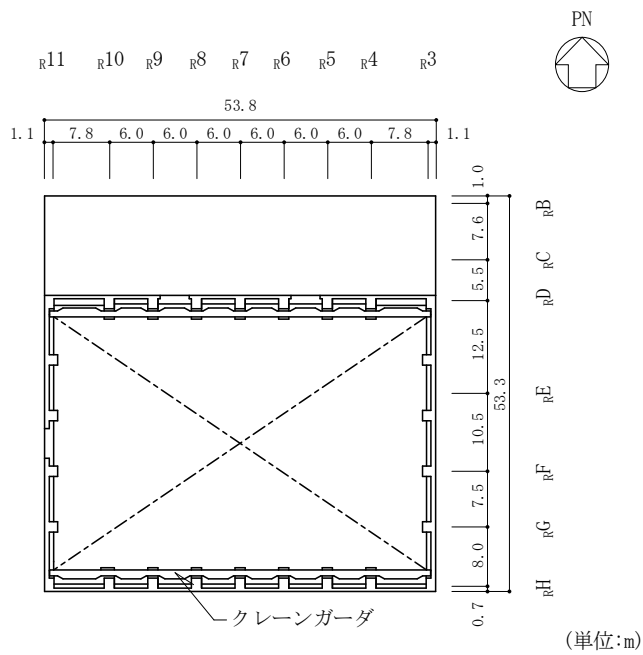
(8) 原子炉建物の概略平面図 (EL 51.7m)
